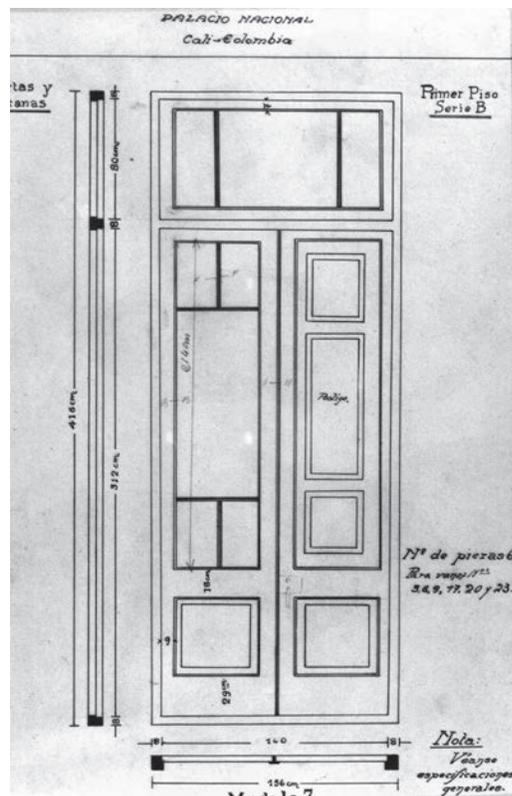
Izquierda, Plano de estudio de carpintería en madera que en su ejecución fue totalmente simplificada. Fuente: Planos originales encontrados en el edificio
